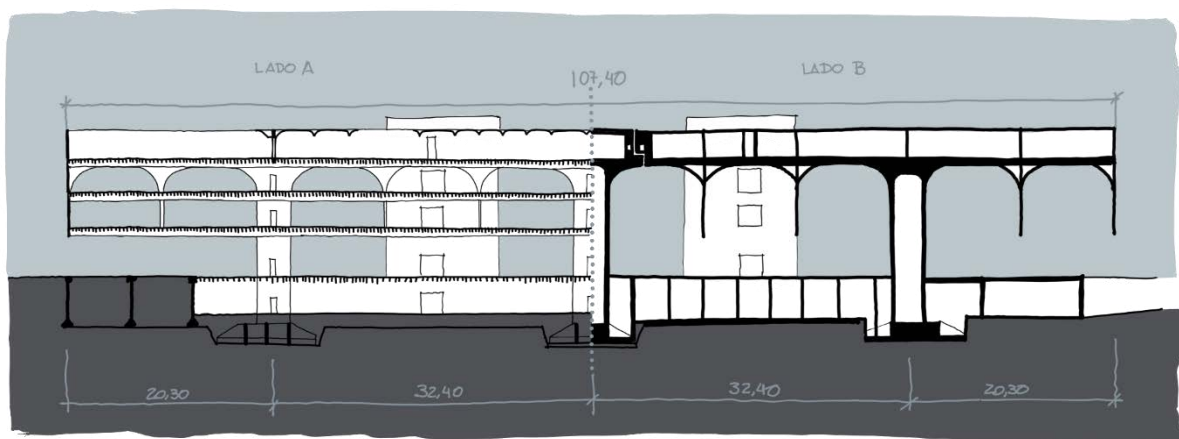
Corte longitudinal lado “A” centro da laje, lado “B” centro da estrutura – desenho nosso. Fonte: (IMBESI, et al., 1991 p. 302)
